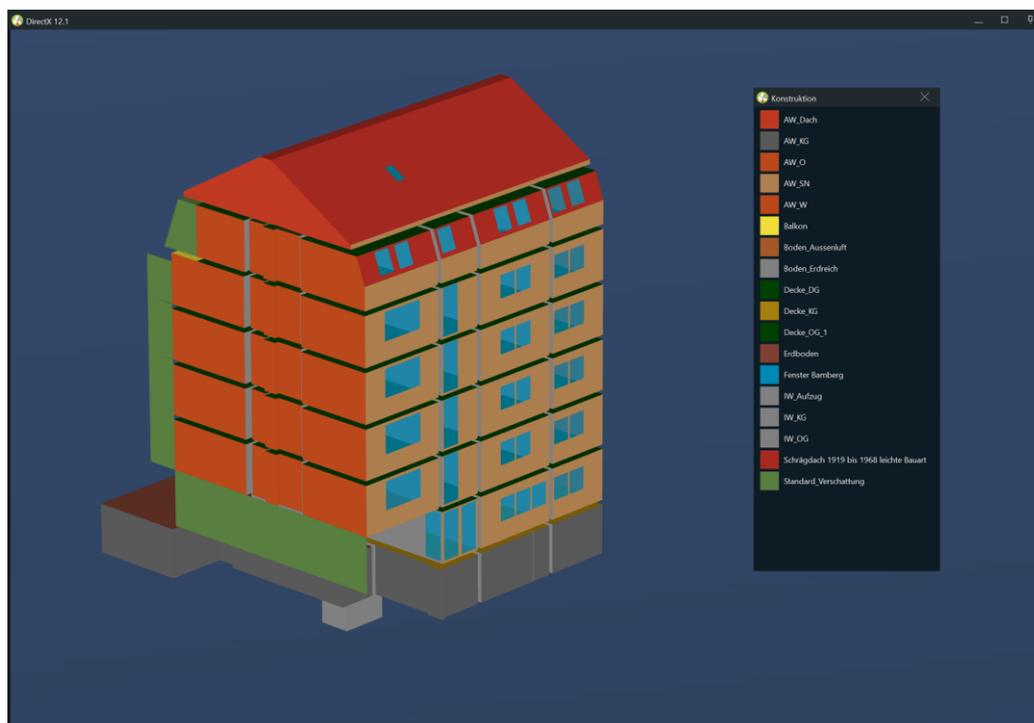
Detailliertes Gebäudemodell Straßenansicht Konstruktionsansicht Variante 2
